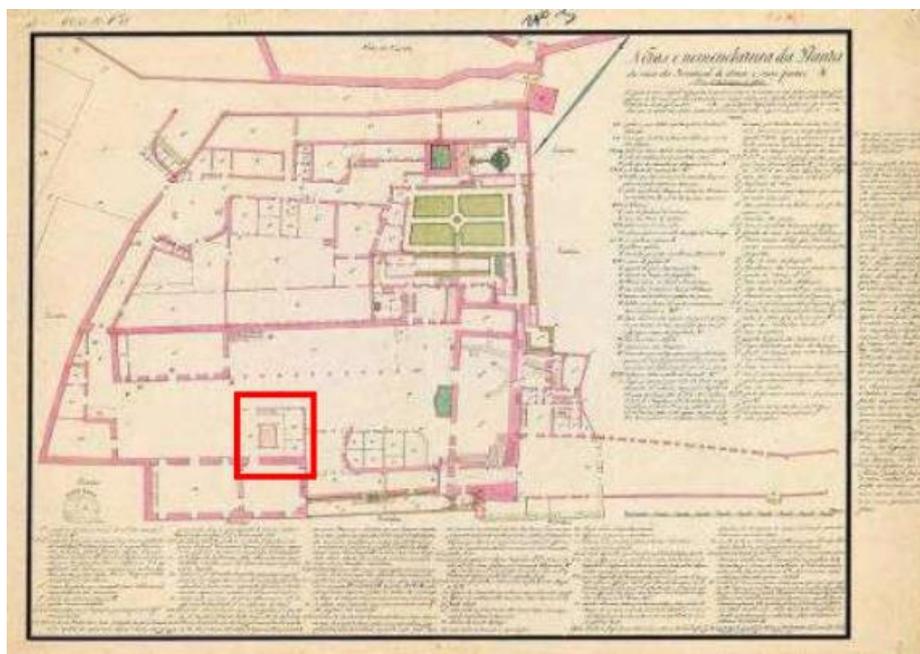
Planta da Fundação de Cima de 1811 Fonte: GEAM/DIE/ Major Calado 2021
